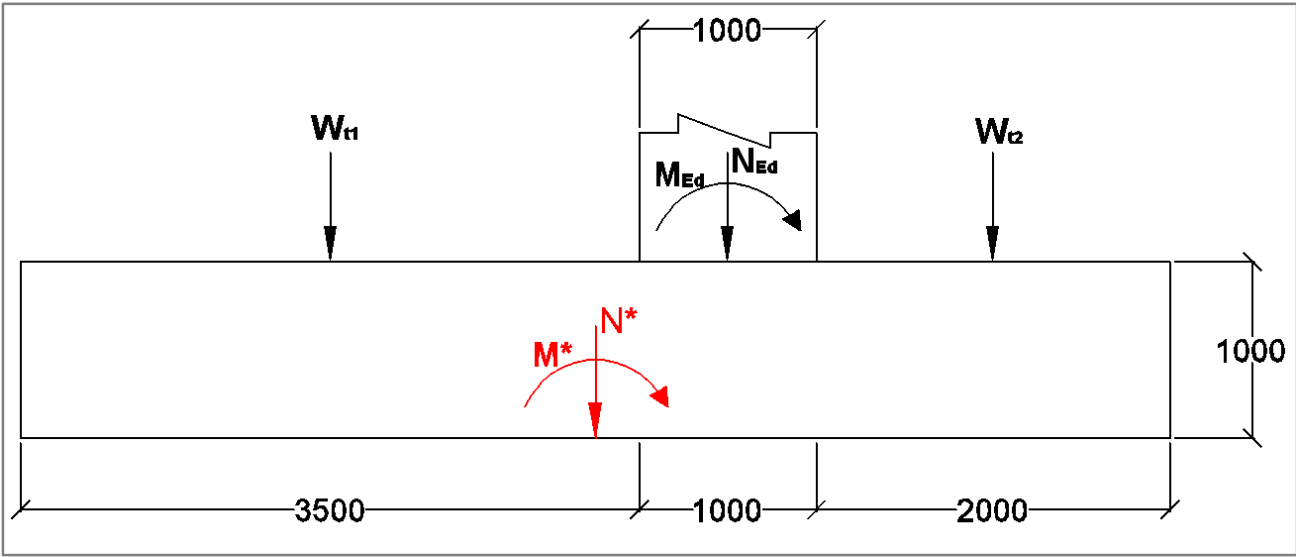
Reducción de esfuerzos al plano de cimentación en el estribo Sur
